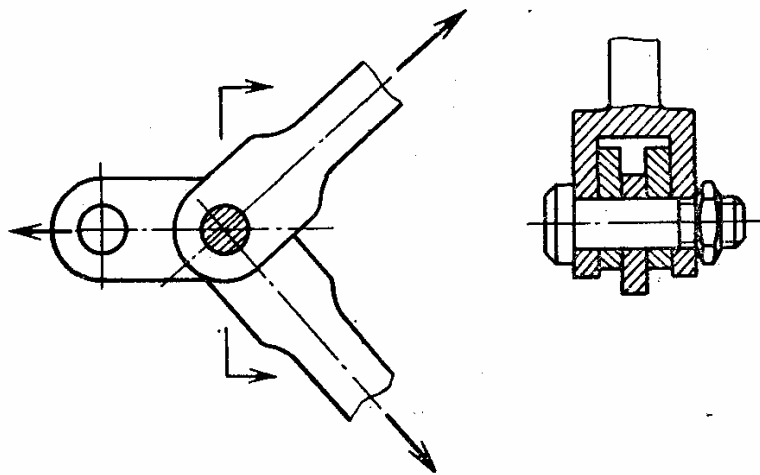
Конструктивная схема шарнирного соединения стержней
